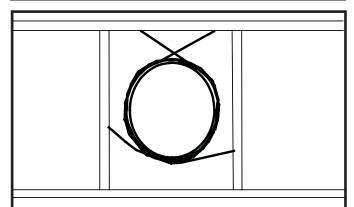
Sujeción de las secciones horizontales del tubo de escape
